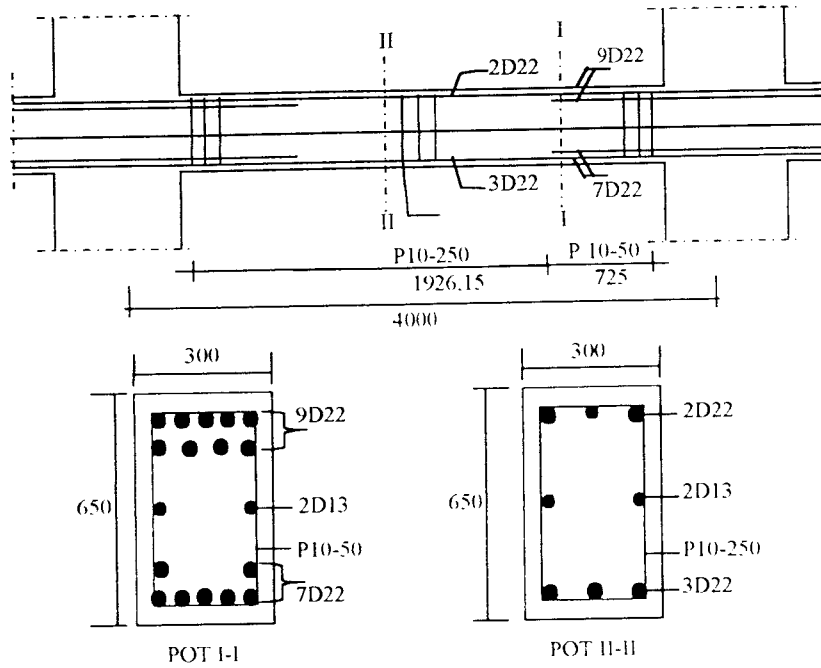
Balok Portal E Bentang 4 m Lantai 3
